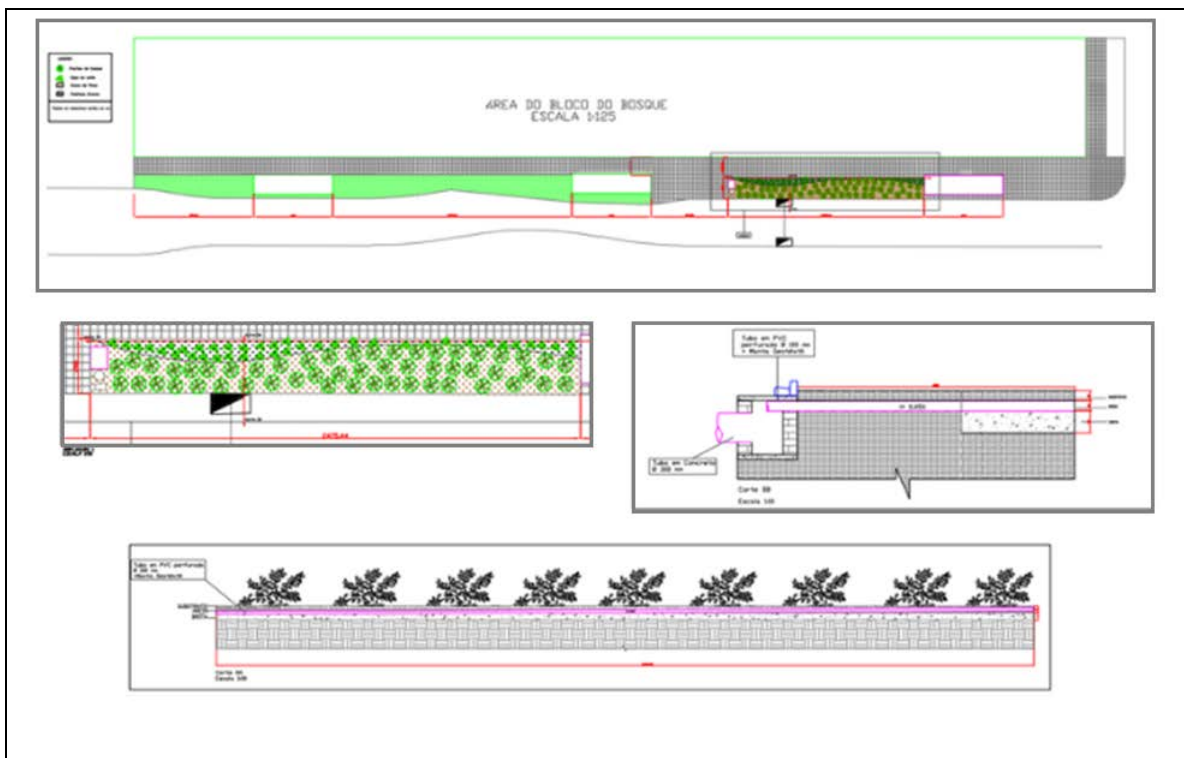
Esquema do Projeto Executivo de Jardim Drenante, camadas de brita 2, areia e substrato.
